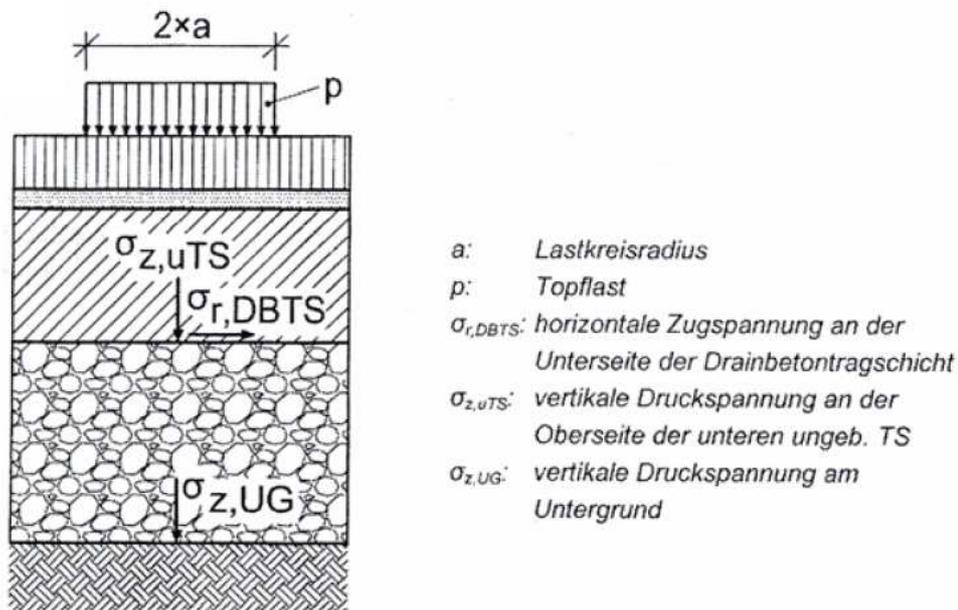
Maßgebende Spannungen bei der Bauweise mit oberer Drainbeton-Tragschicht [14]
